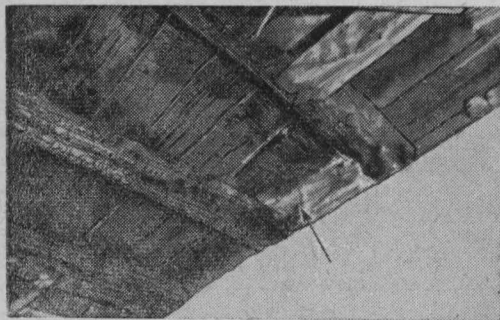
Участок перекрытия в зоне очага пожара. Средняя балка введена в канал дымохода, стрелкой указано незаделанное отверстие в гнезде балки.
